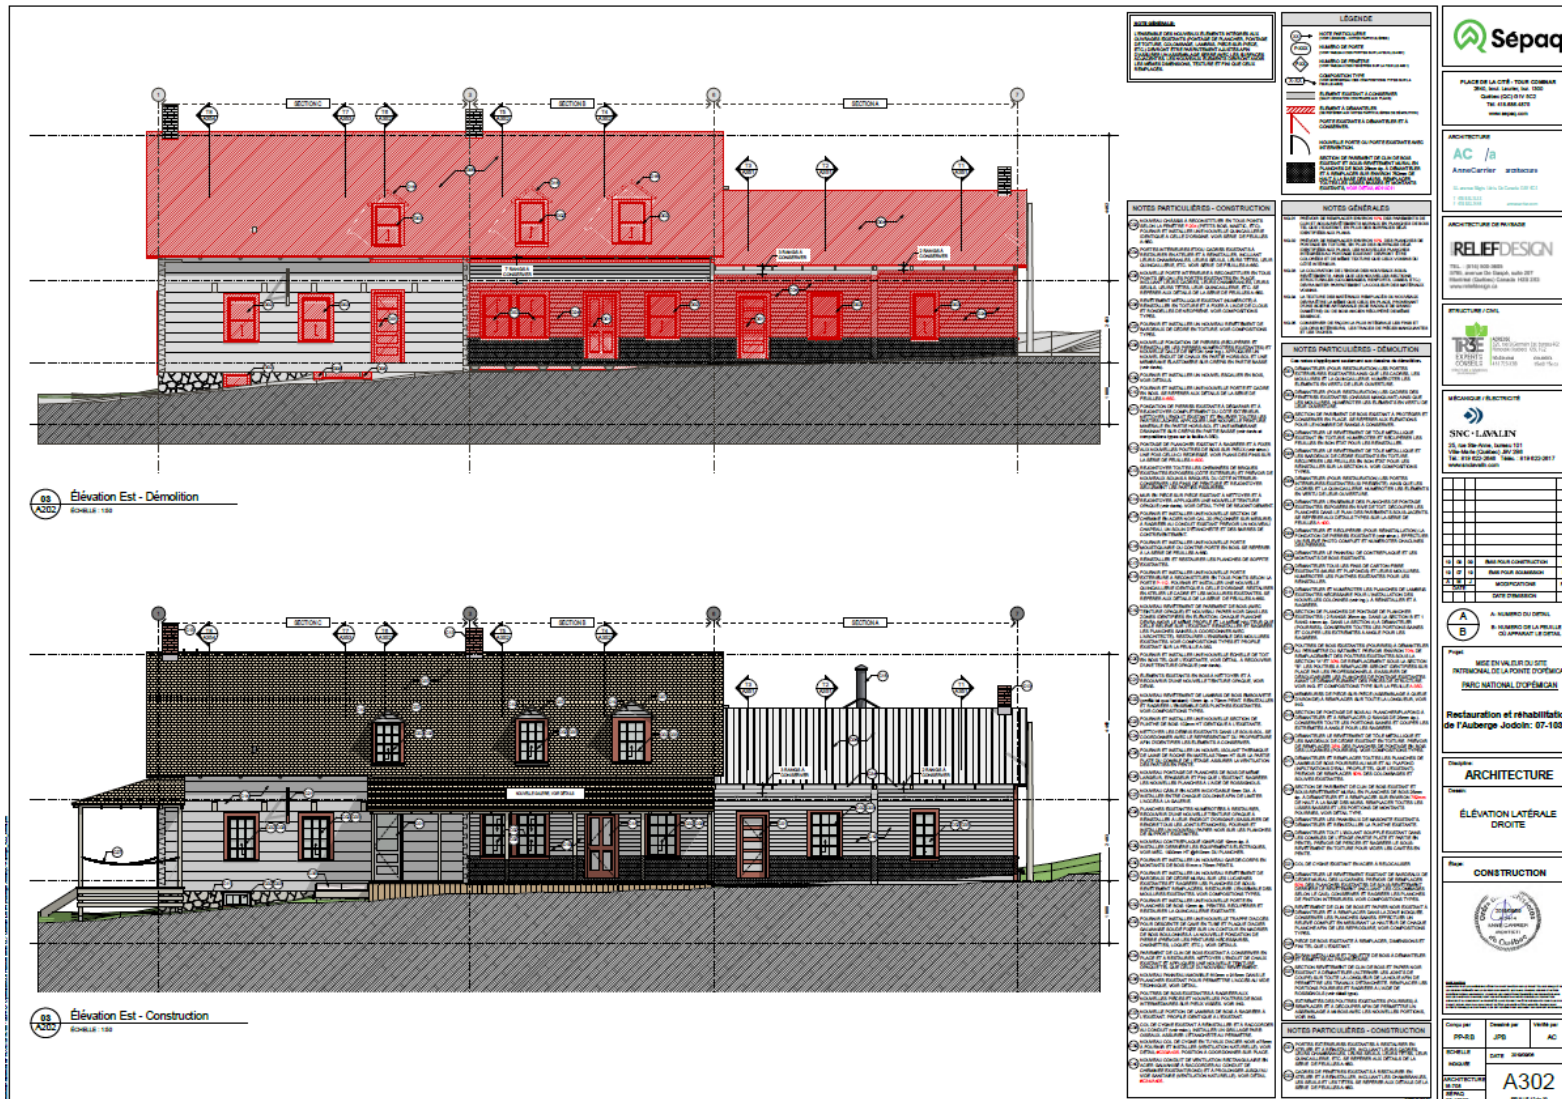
Plan de construction montrant la façade est de l'auberge Jodoïn (Source : Sépaq).
